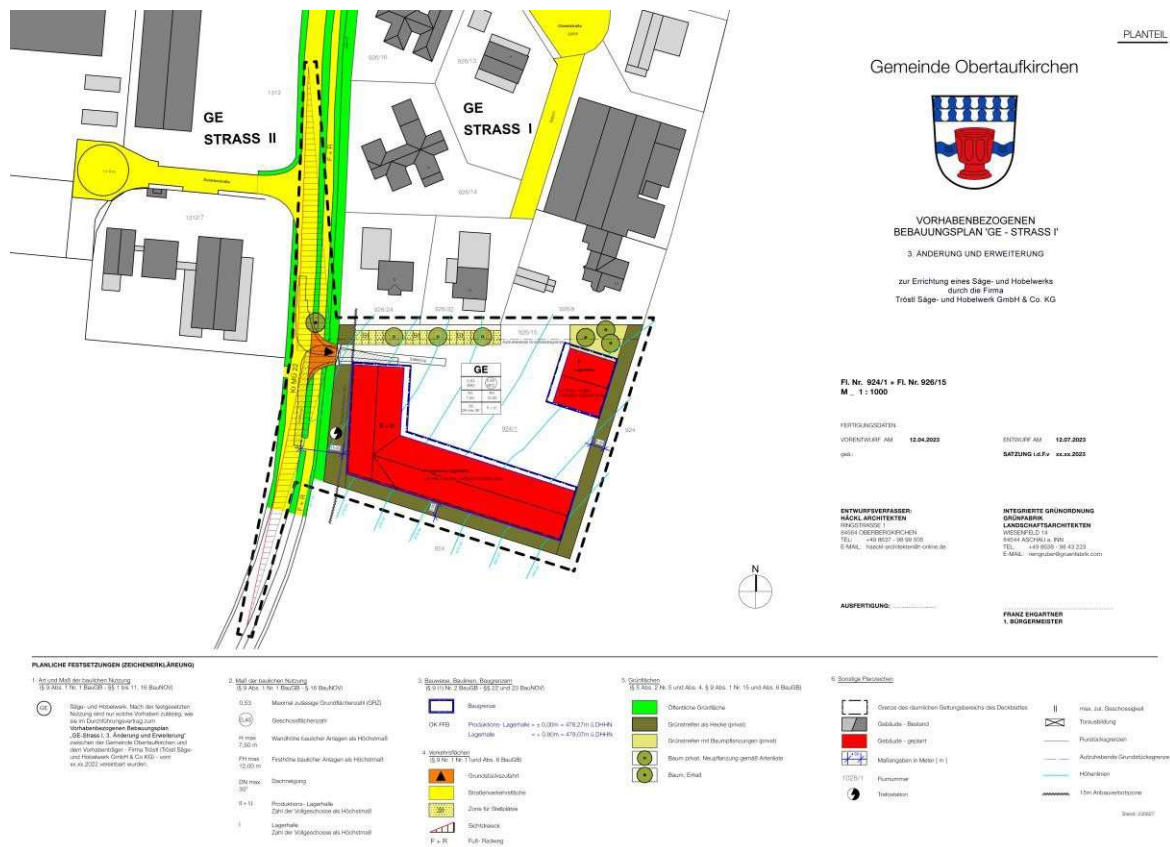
Bebauungsplan „GE-Strass I, 3. Änderung und Erweiterung“
